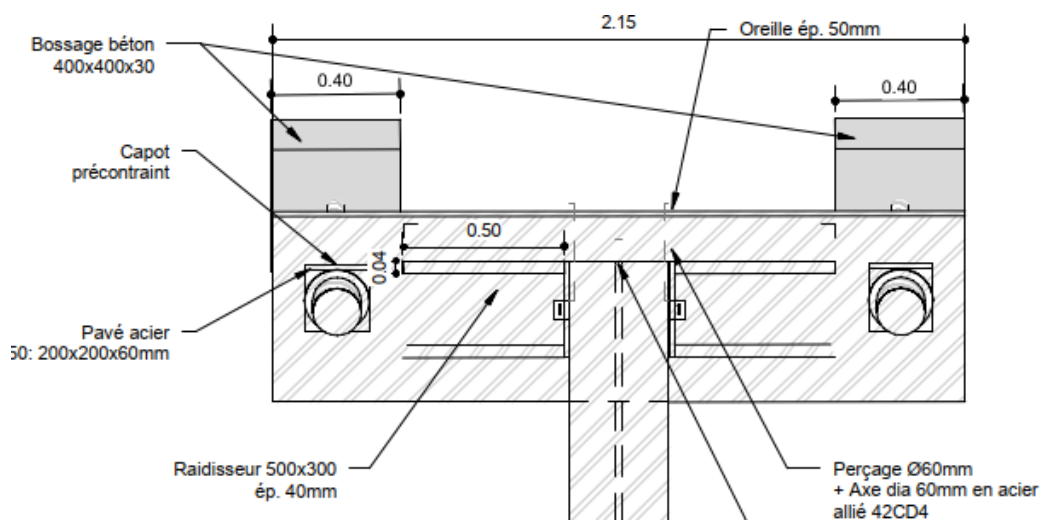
Élévation de la fixation supérieure pour un voussoir sur pile
